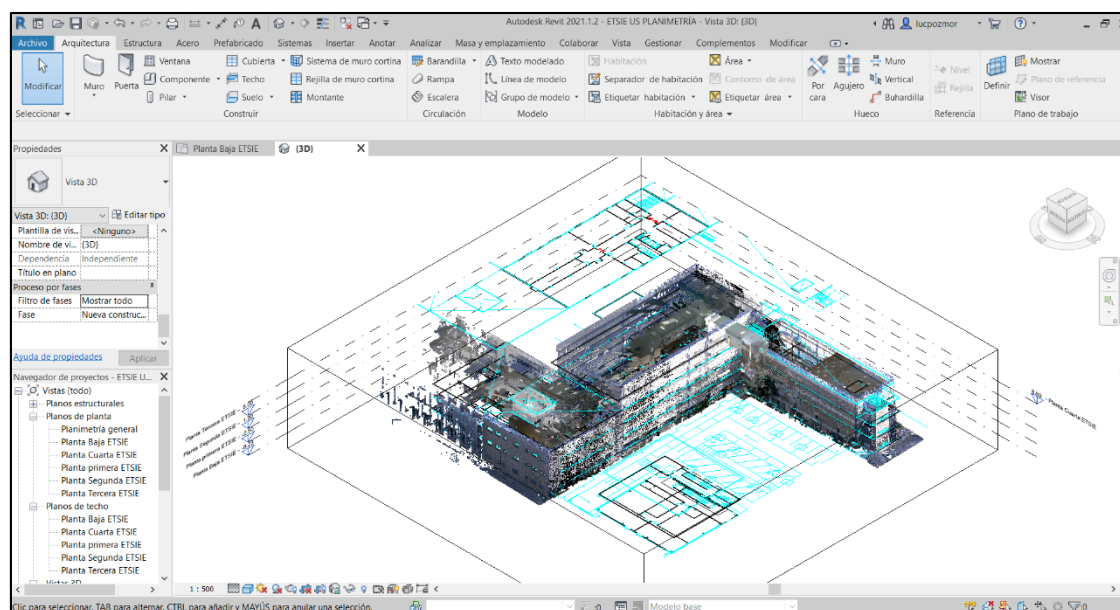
Vista 3D de la nube de puntos con la planimetría aportada en REVIT
